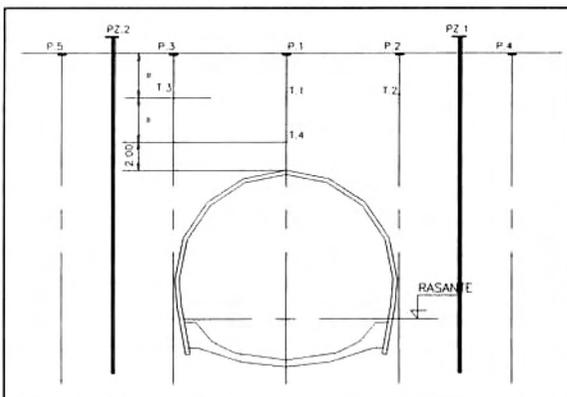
Exemplo da instrumentação de uma secção de tipo C (Corte transversal).
